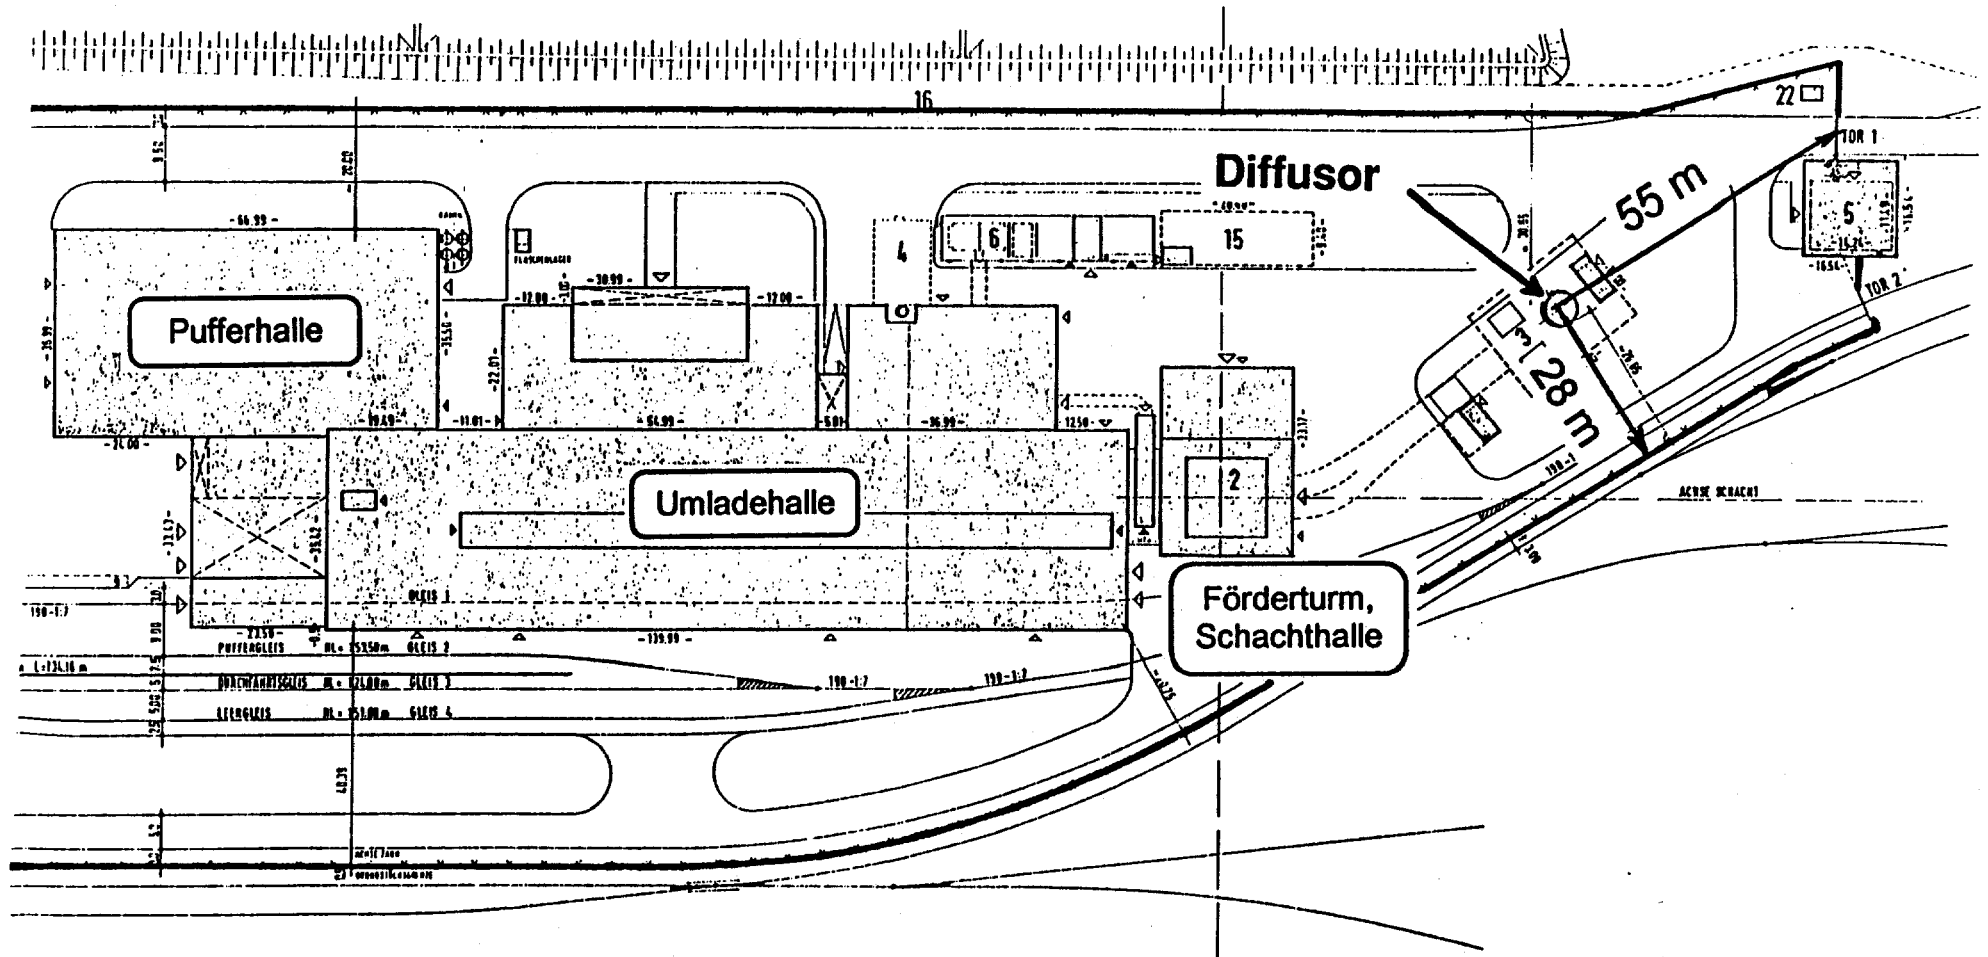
Lageplan des übertägigen Betriebsgeländes (Ausschnitt): Lage des Diffusors zum Anlagenzaun
